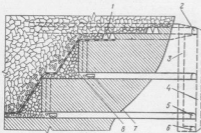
Система разработки с подэтажным обрушением и искусственной подвальной кровлей (гибким перекрытием):
